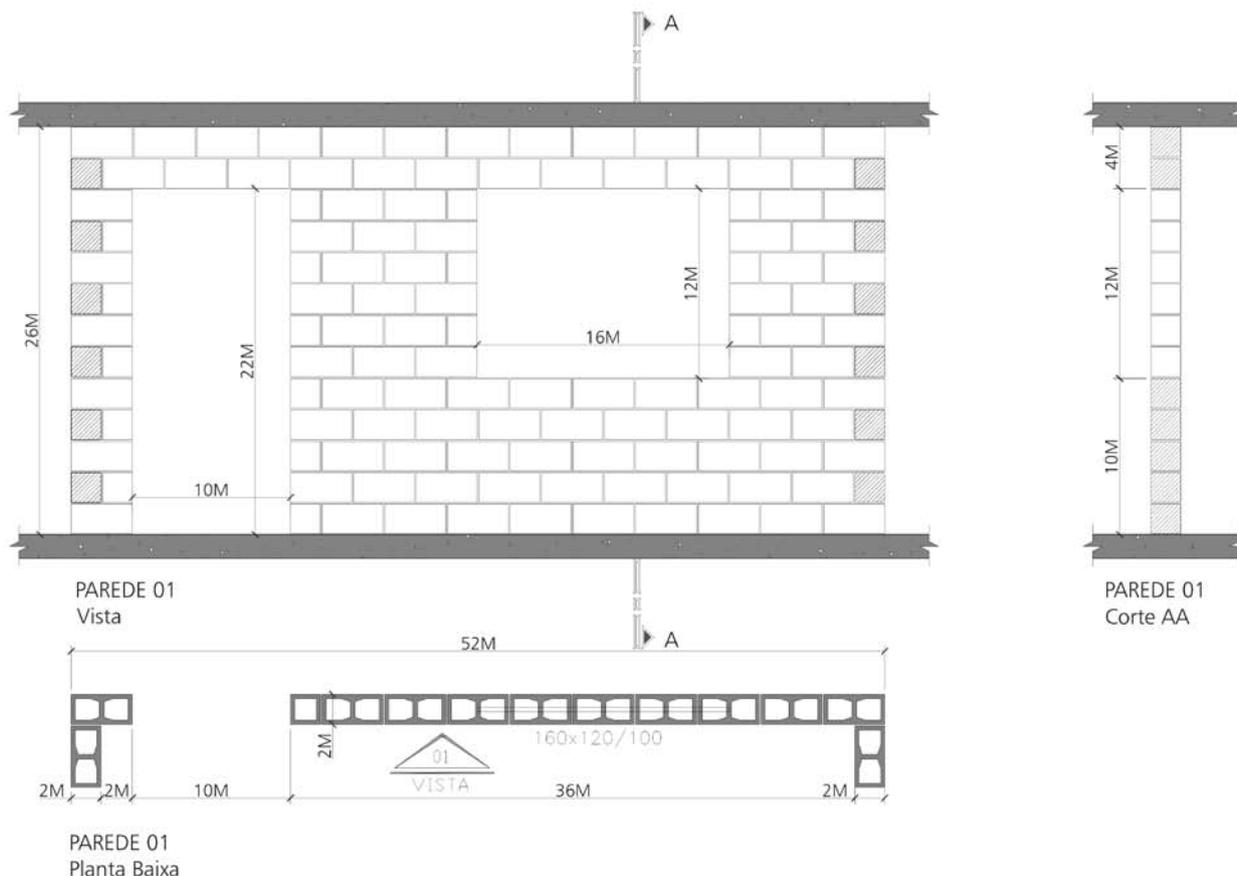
Elevação de parede executada em alvenaria modular de blocos
